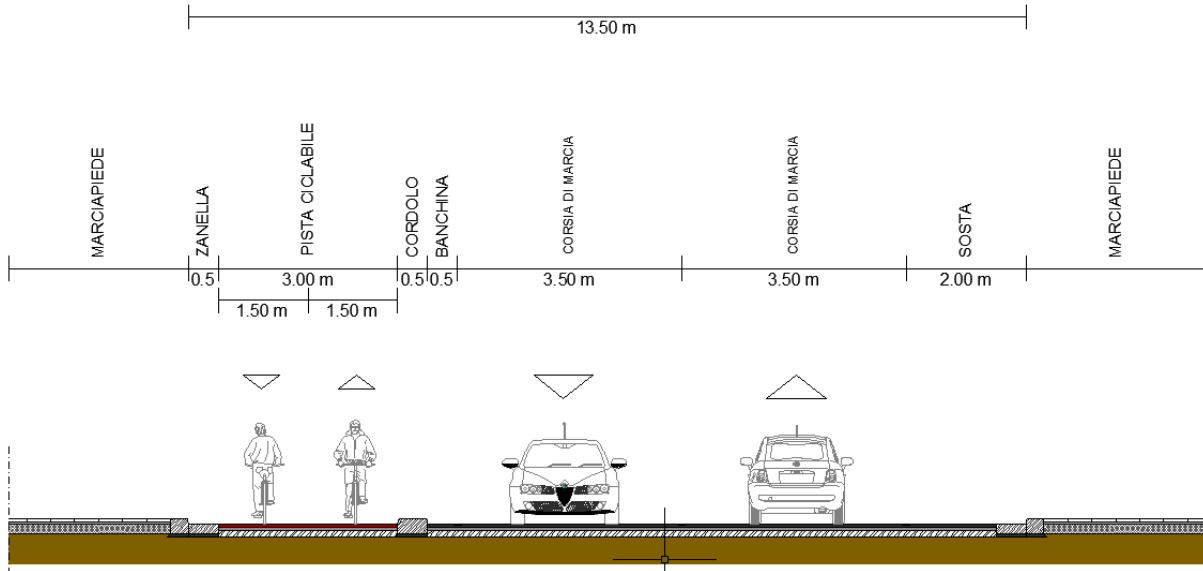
via Antonino Pio – tratto tra via Adriano e Traversa Antonino Pio, sezione trasversale di progetto.
